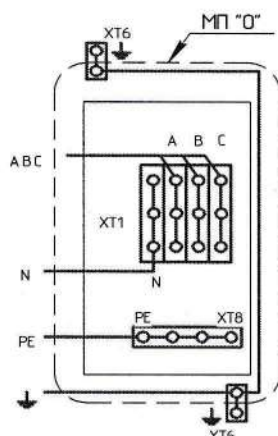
Модуль присоединительный для ЩОВ-XX0Б
